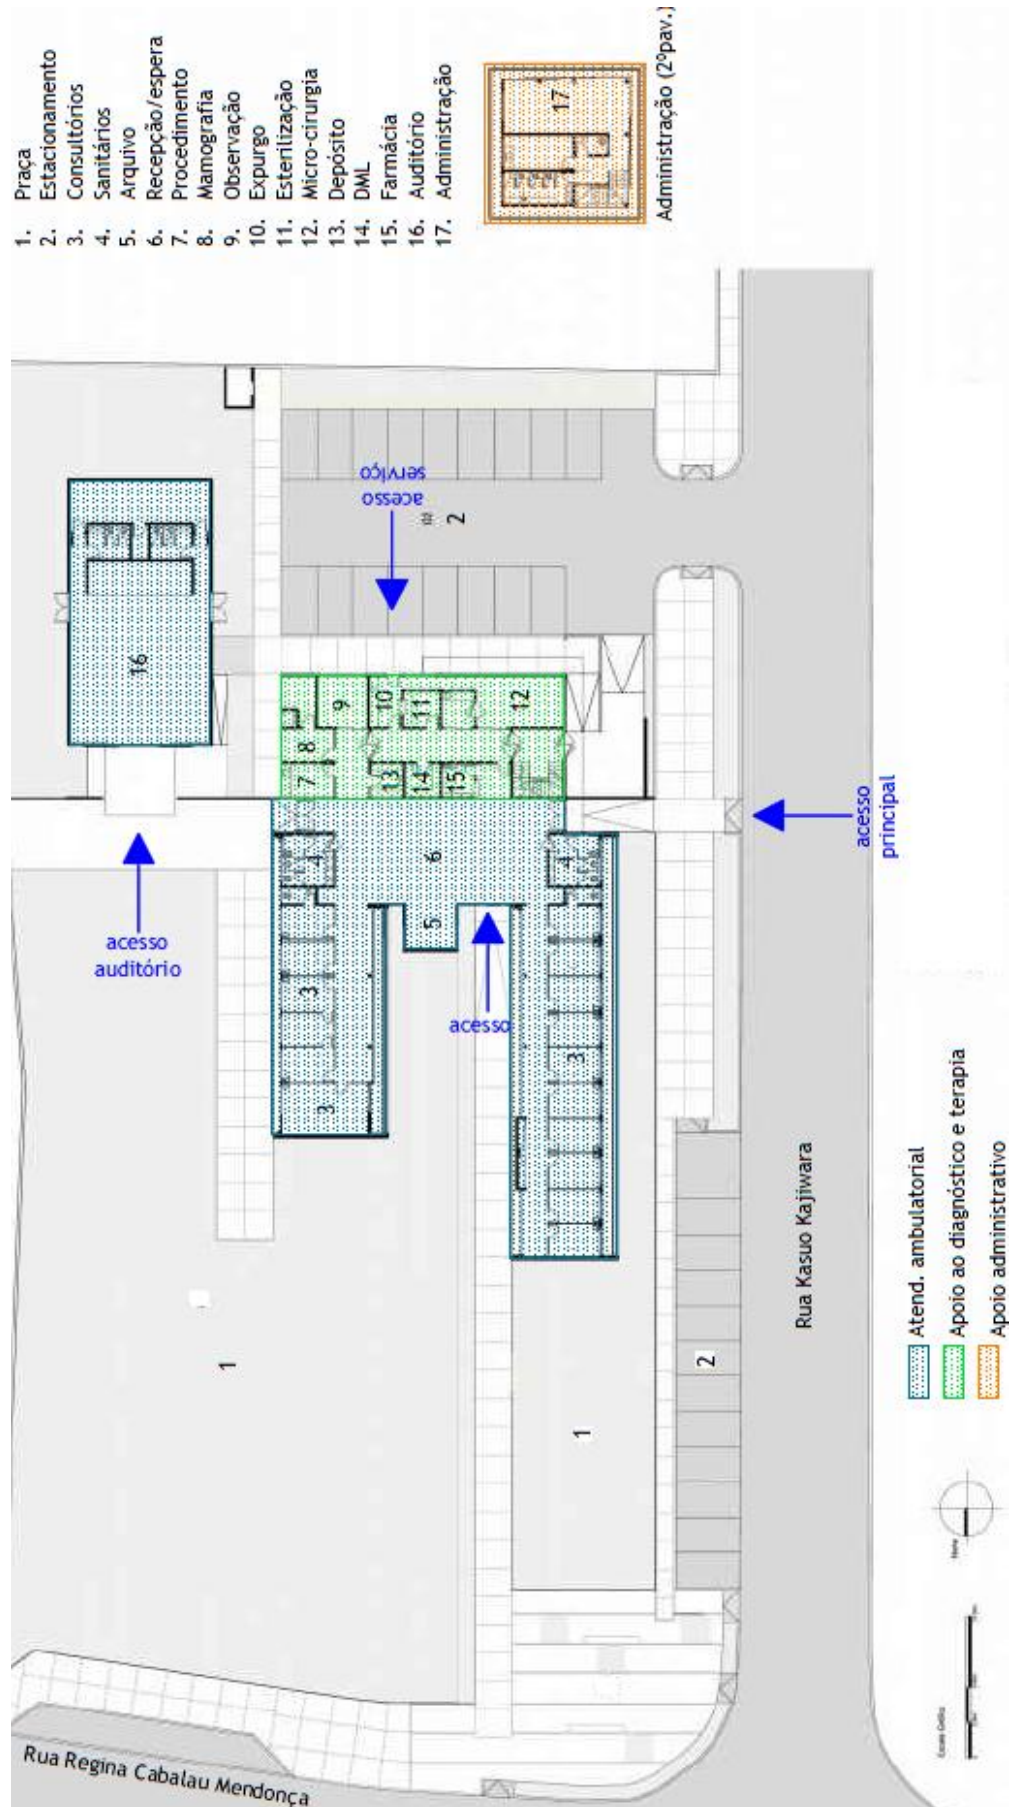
Planta pavimento térreo + bloco administração no segundo pavimento (FONTE: BASULTO, 2010), adaptado
